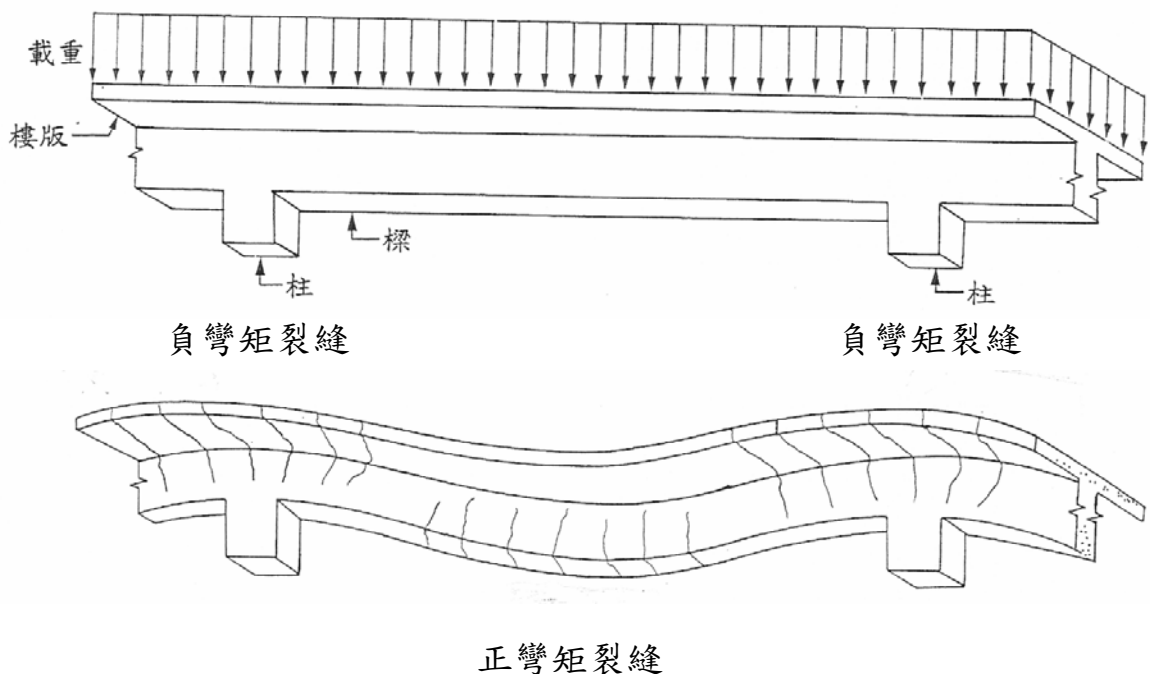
鋼筋混凝土樑的正彎矩與負彎矩裂縫
